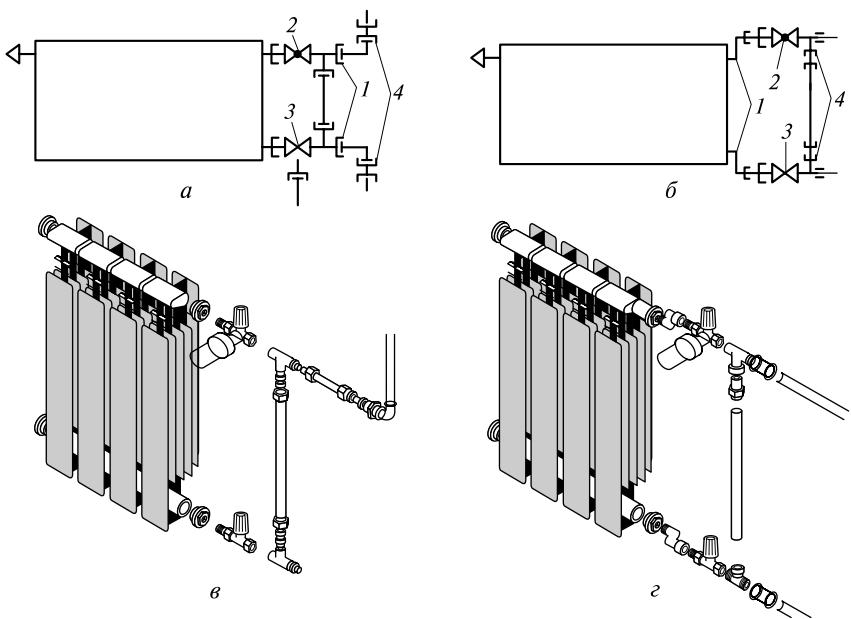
Боковое подключение радиатора на металлопластиковых и стальных трубах:
